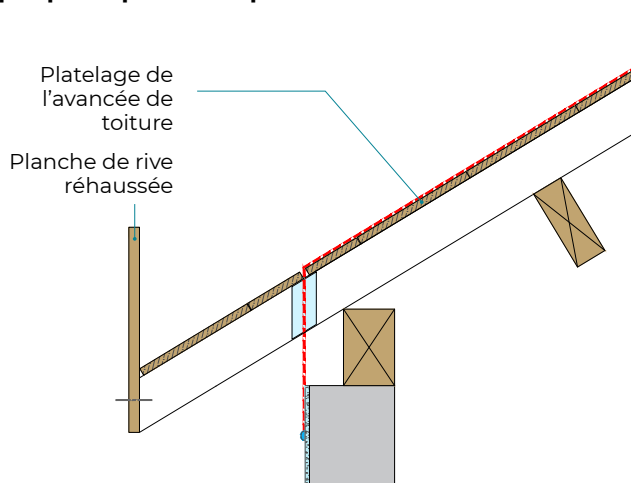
Mise en œuvre du platelage périphérique et des planches de rives
